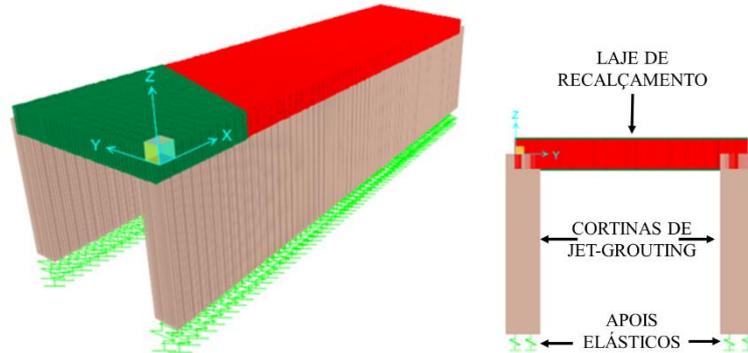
Modelo de análise SAP2000 para a laje de fundação.
